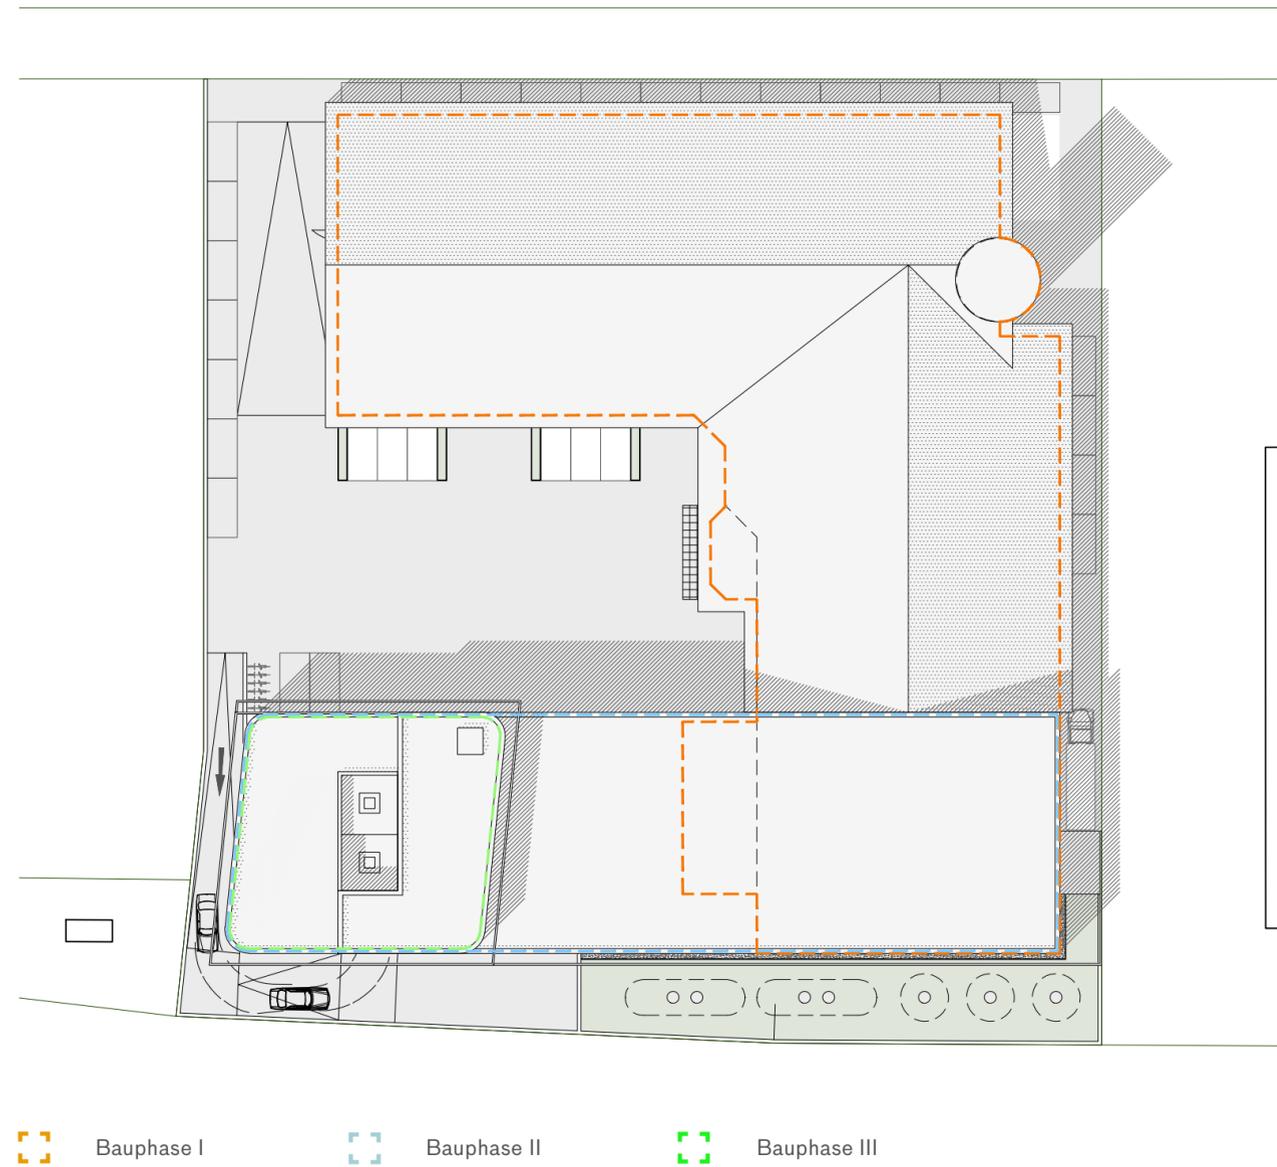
Entwurf - Dachdraufsicht - Bauphasen
